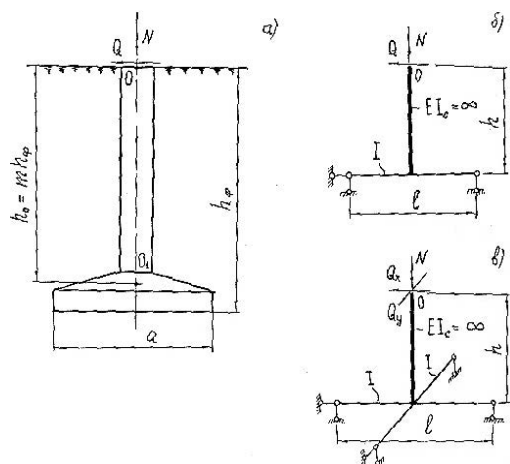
Преобразование фундамента - железобетонного подножника (а) в грунтовом основании в стержневой аналог для плоской (б) и пространственной задачи (в)
